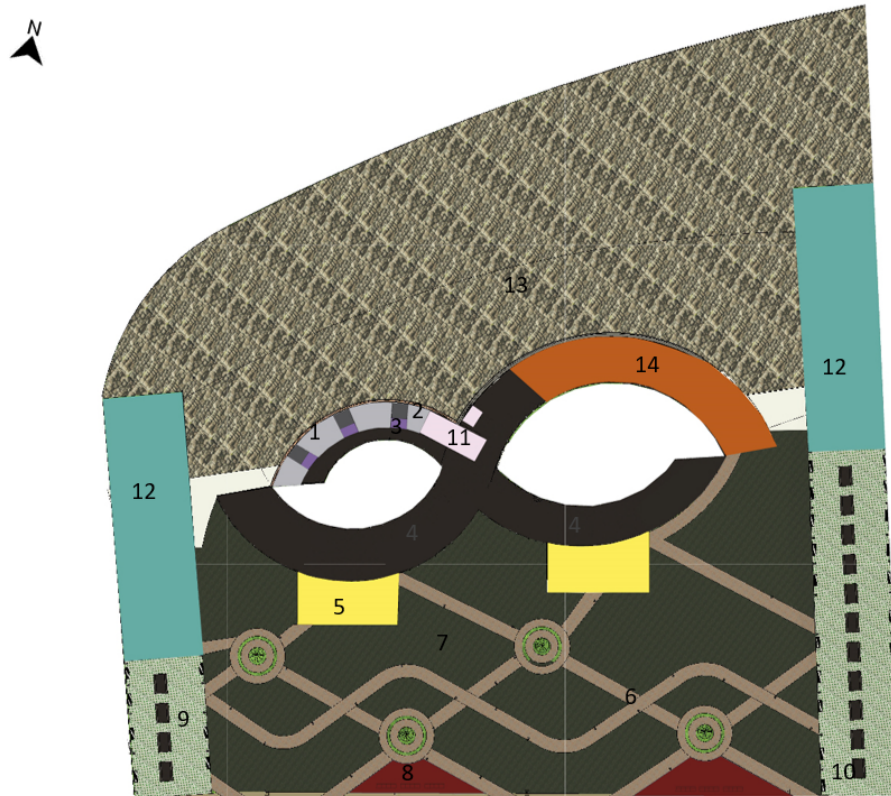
Segunda Planta. Fuente y elaboración: Propia.
